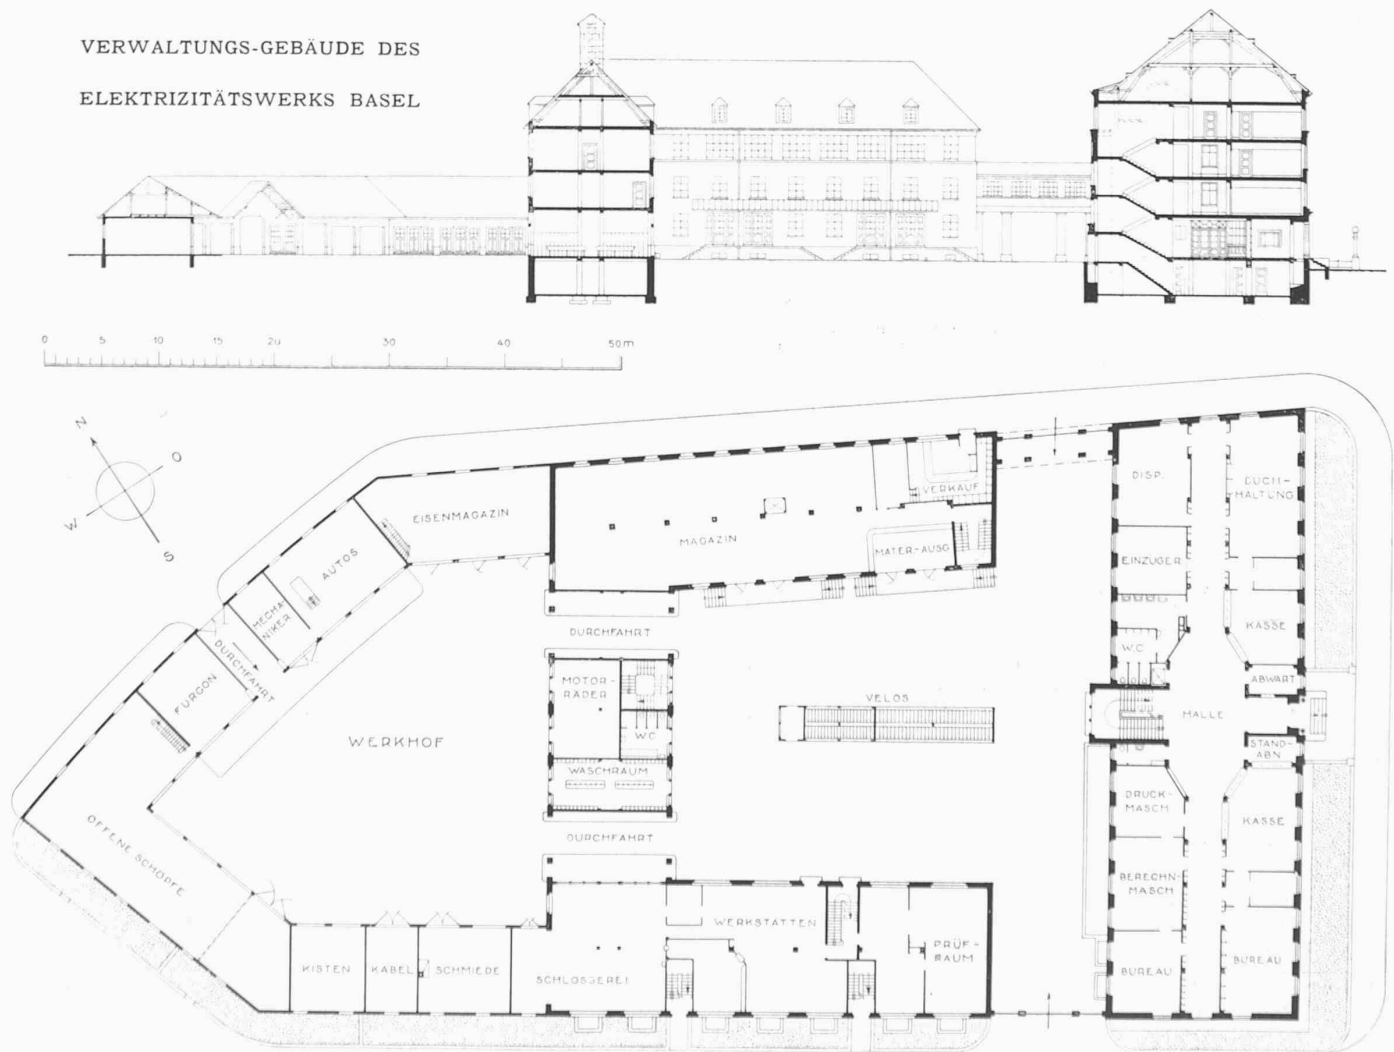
Erdgeschoss-Grundriss, Abb. 2 Schnitt der Gesamtanlage. — Masstab 1 : 600. — (Text hierzu Seite 141.)
